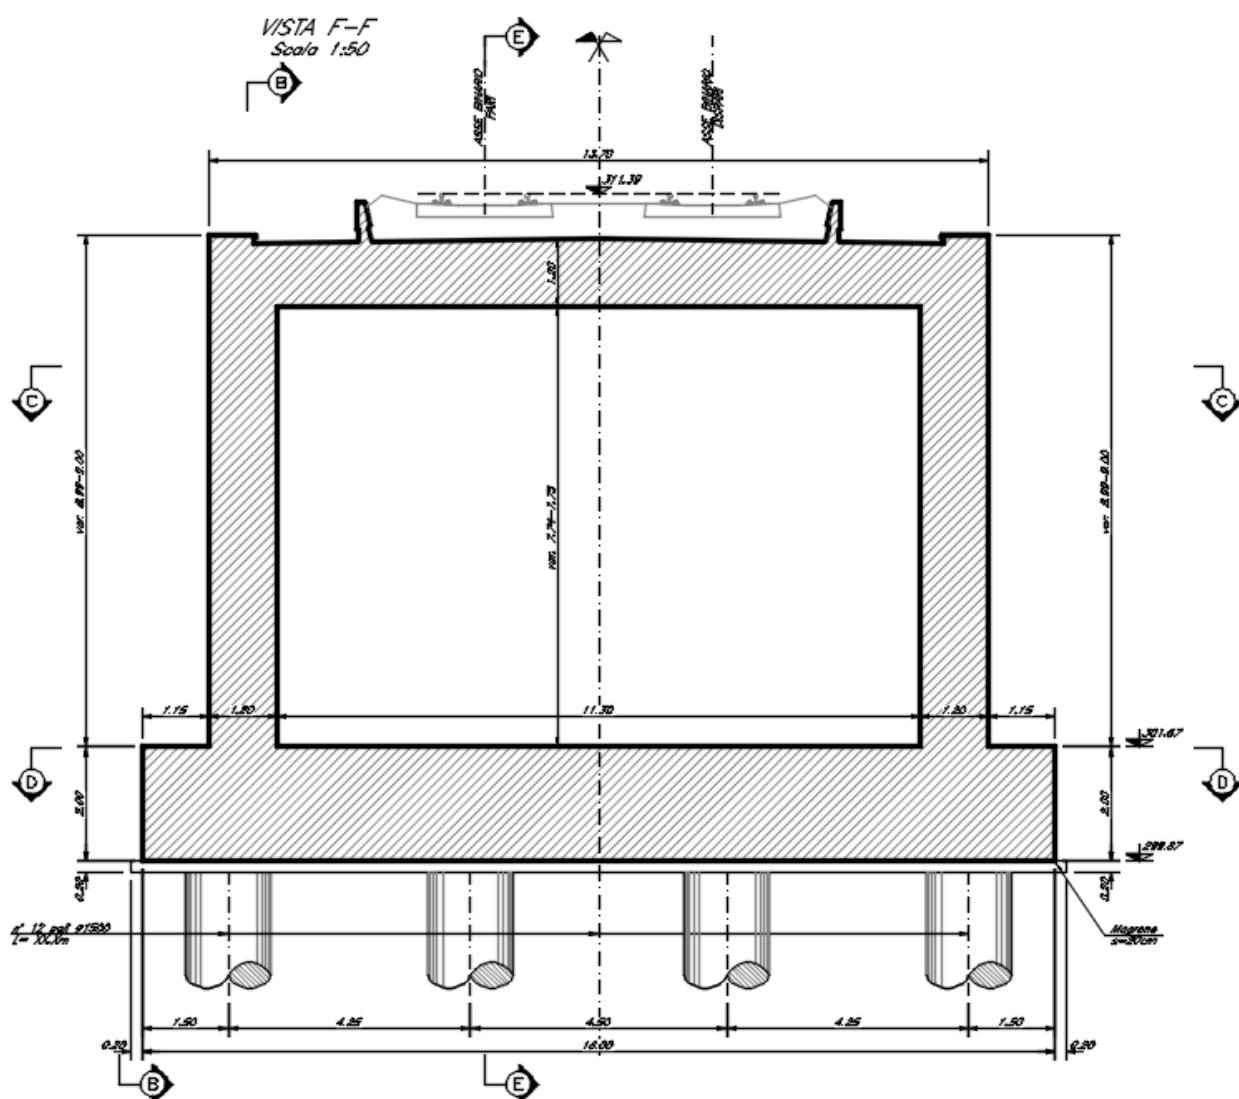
Dettaglio sezione trasversale spalla B
